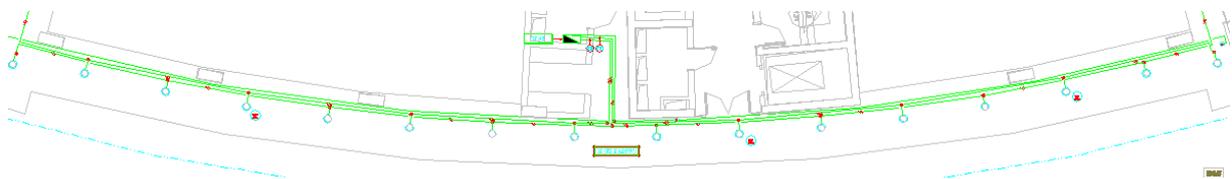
Planta da circulação de piso do edifício em estudo
